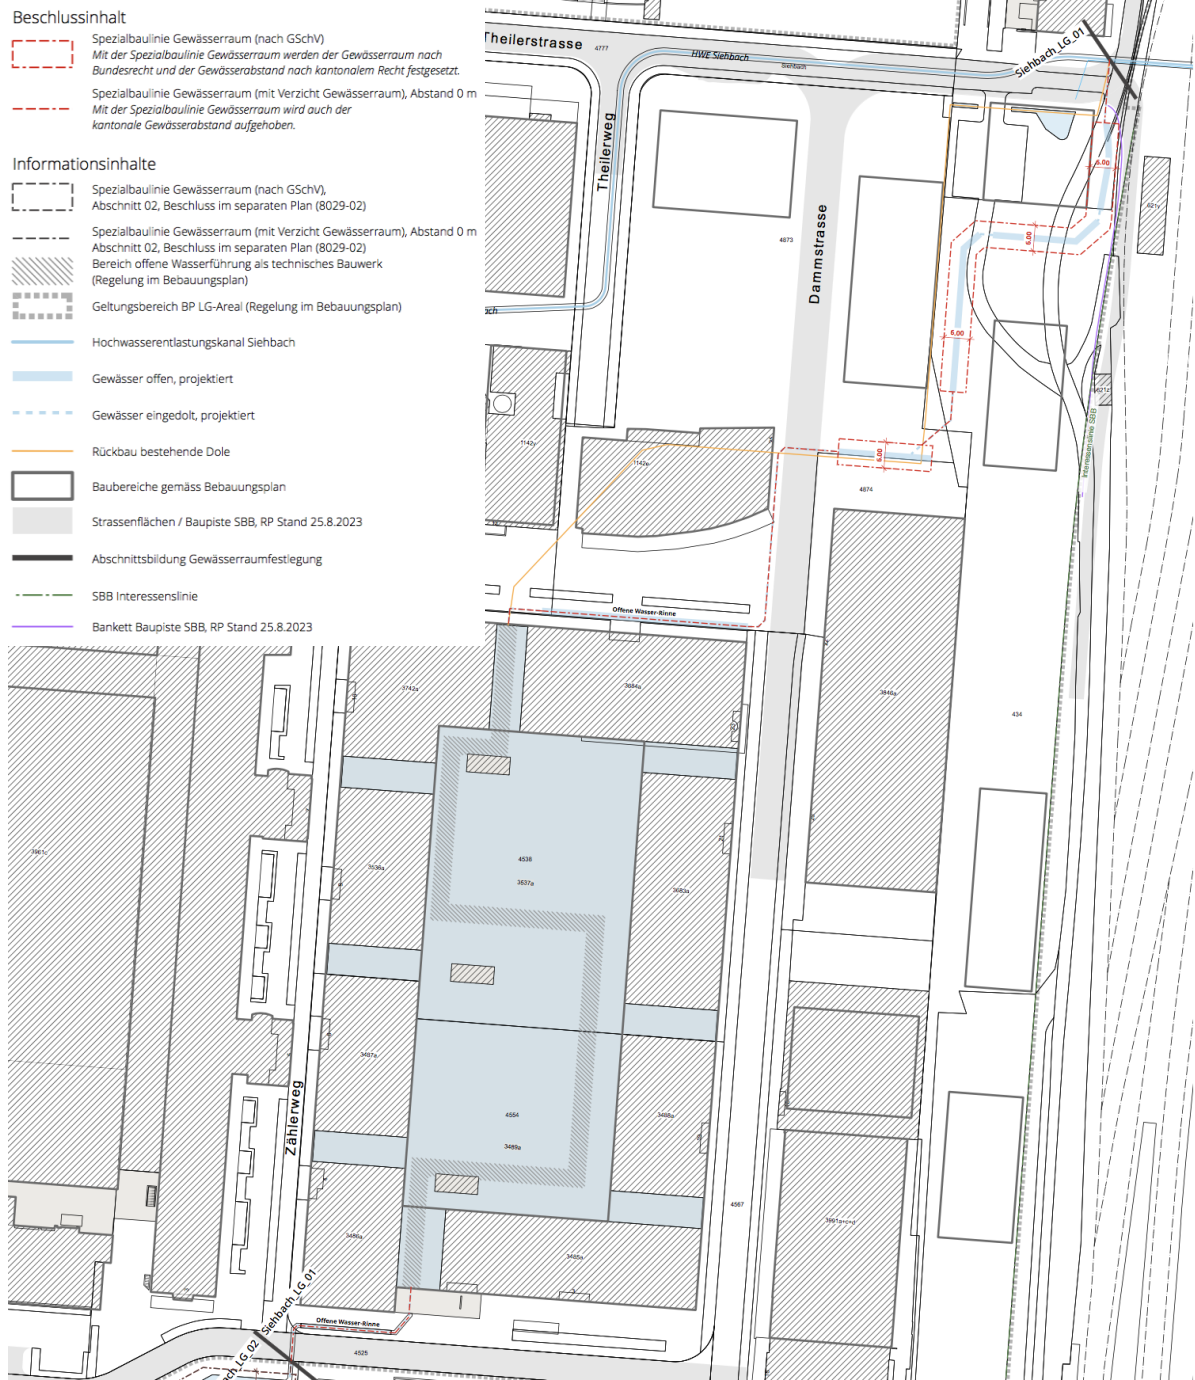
Ausschnitt Baulinienplan Abschnitt 01, Teilbereich Bebauungsplan LG-Areal (Quelle: Suter von Känel Wild, Stand 16. Januar 2024, öffentliche Auflage)
